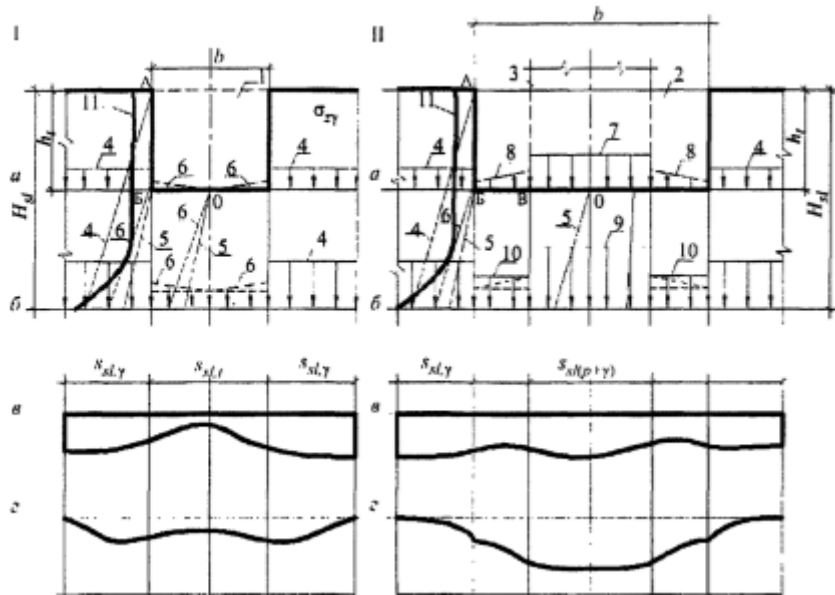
Схемы к расчету просадок: I – грунта при устройстве глубокой выемки; II – фундамента подземной части здания или сооружения
